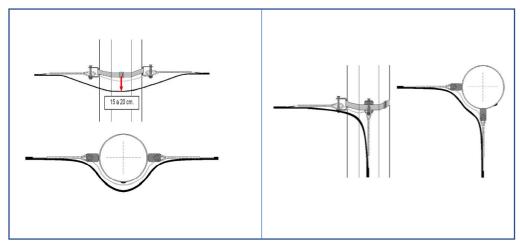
FIGURA CON VISTA DE PLANTA Y VISTA FRONTAL DE HERRAJES TIPO TENSIÓN Fuente: Lineamientos Técnicos y Administrativos del SEN año 2014.
